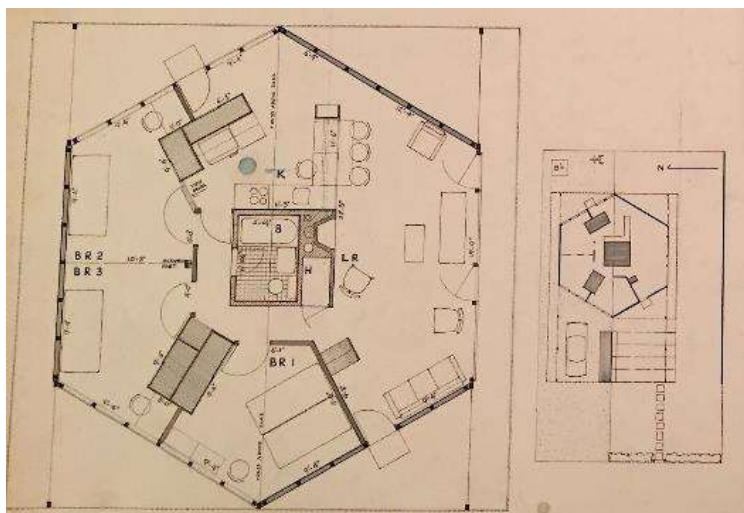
Detalles planos para el concurso NAHB-Forum, 1950.
